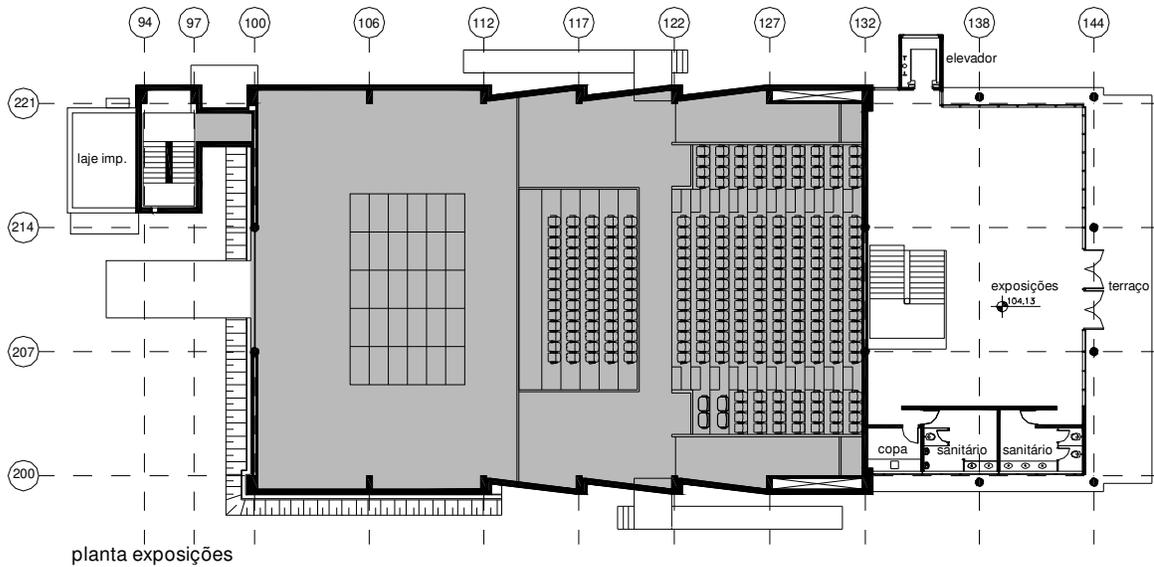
Planta do Pavimento Superior (Exposições) – Teatro Santa Cruz – Sem Escala
